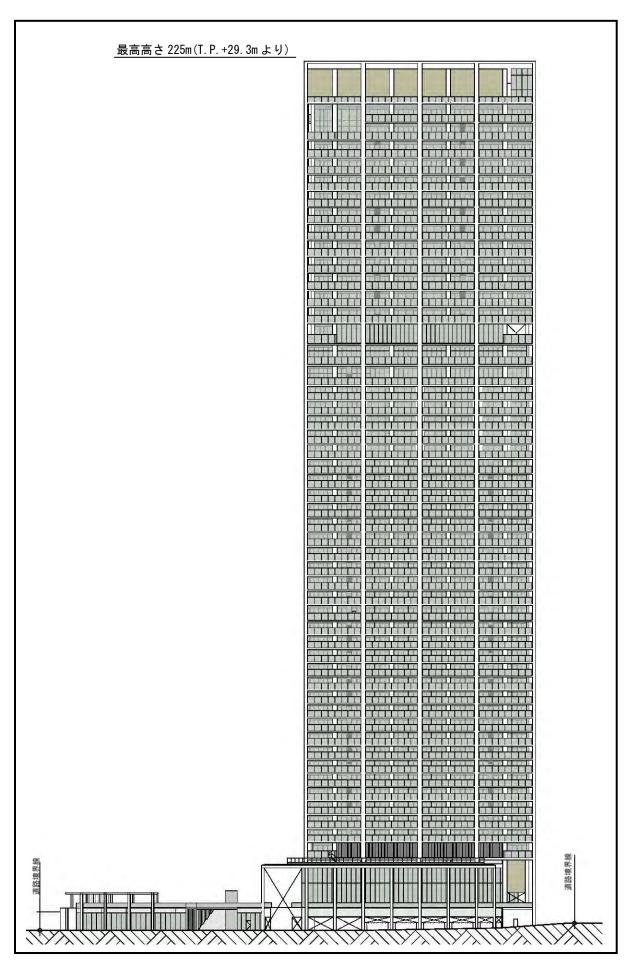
(4) 立面図 (東立面図 S=1:1,000)【変更後】
